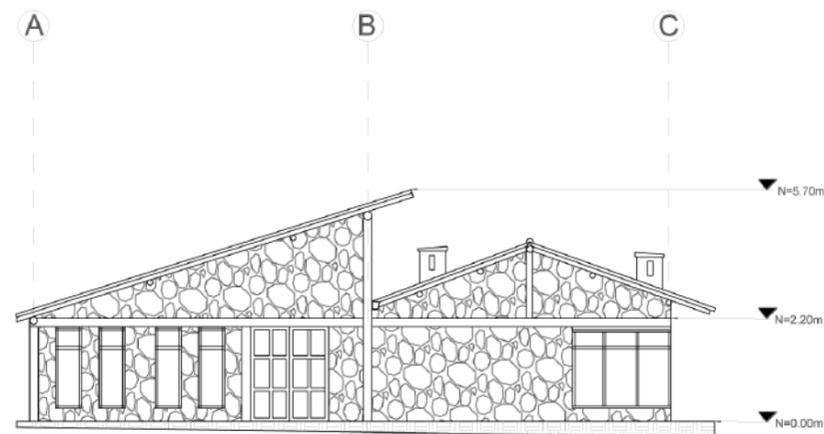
ELEVACIÓN FRONTAL PROPUESTA
